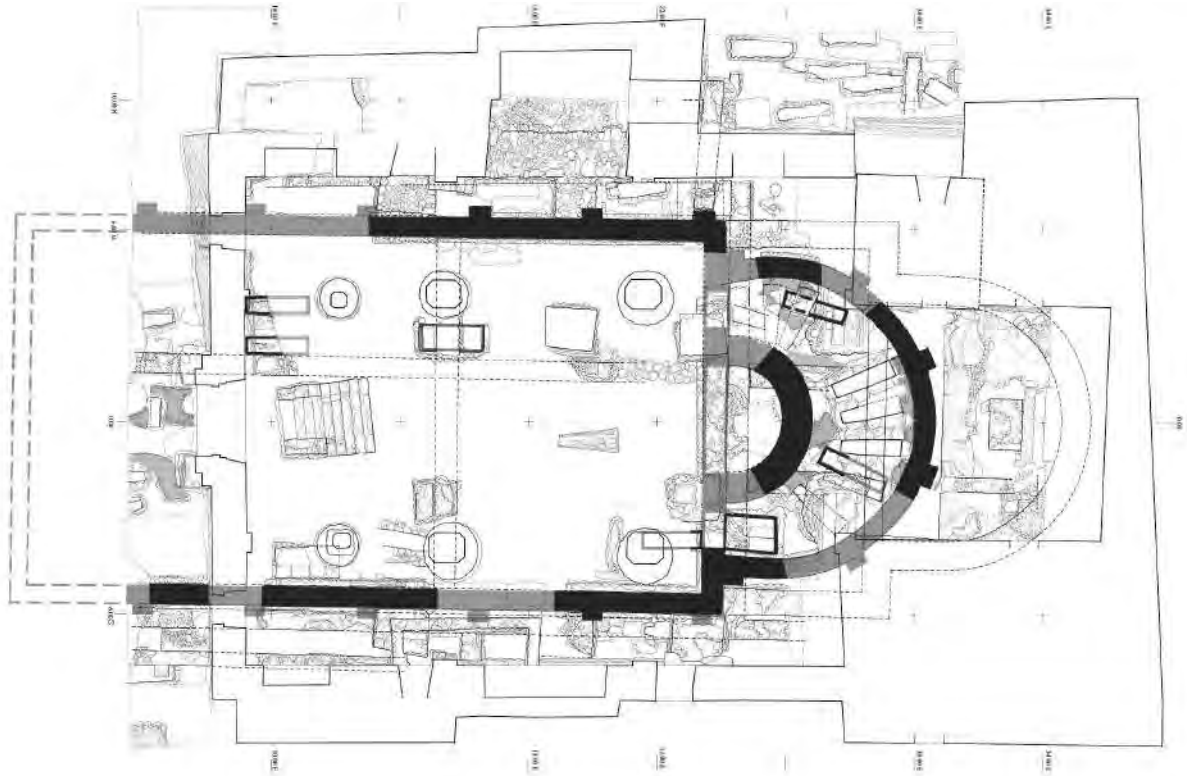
Chiesa S. Stefano: Planimetria fase I.
